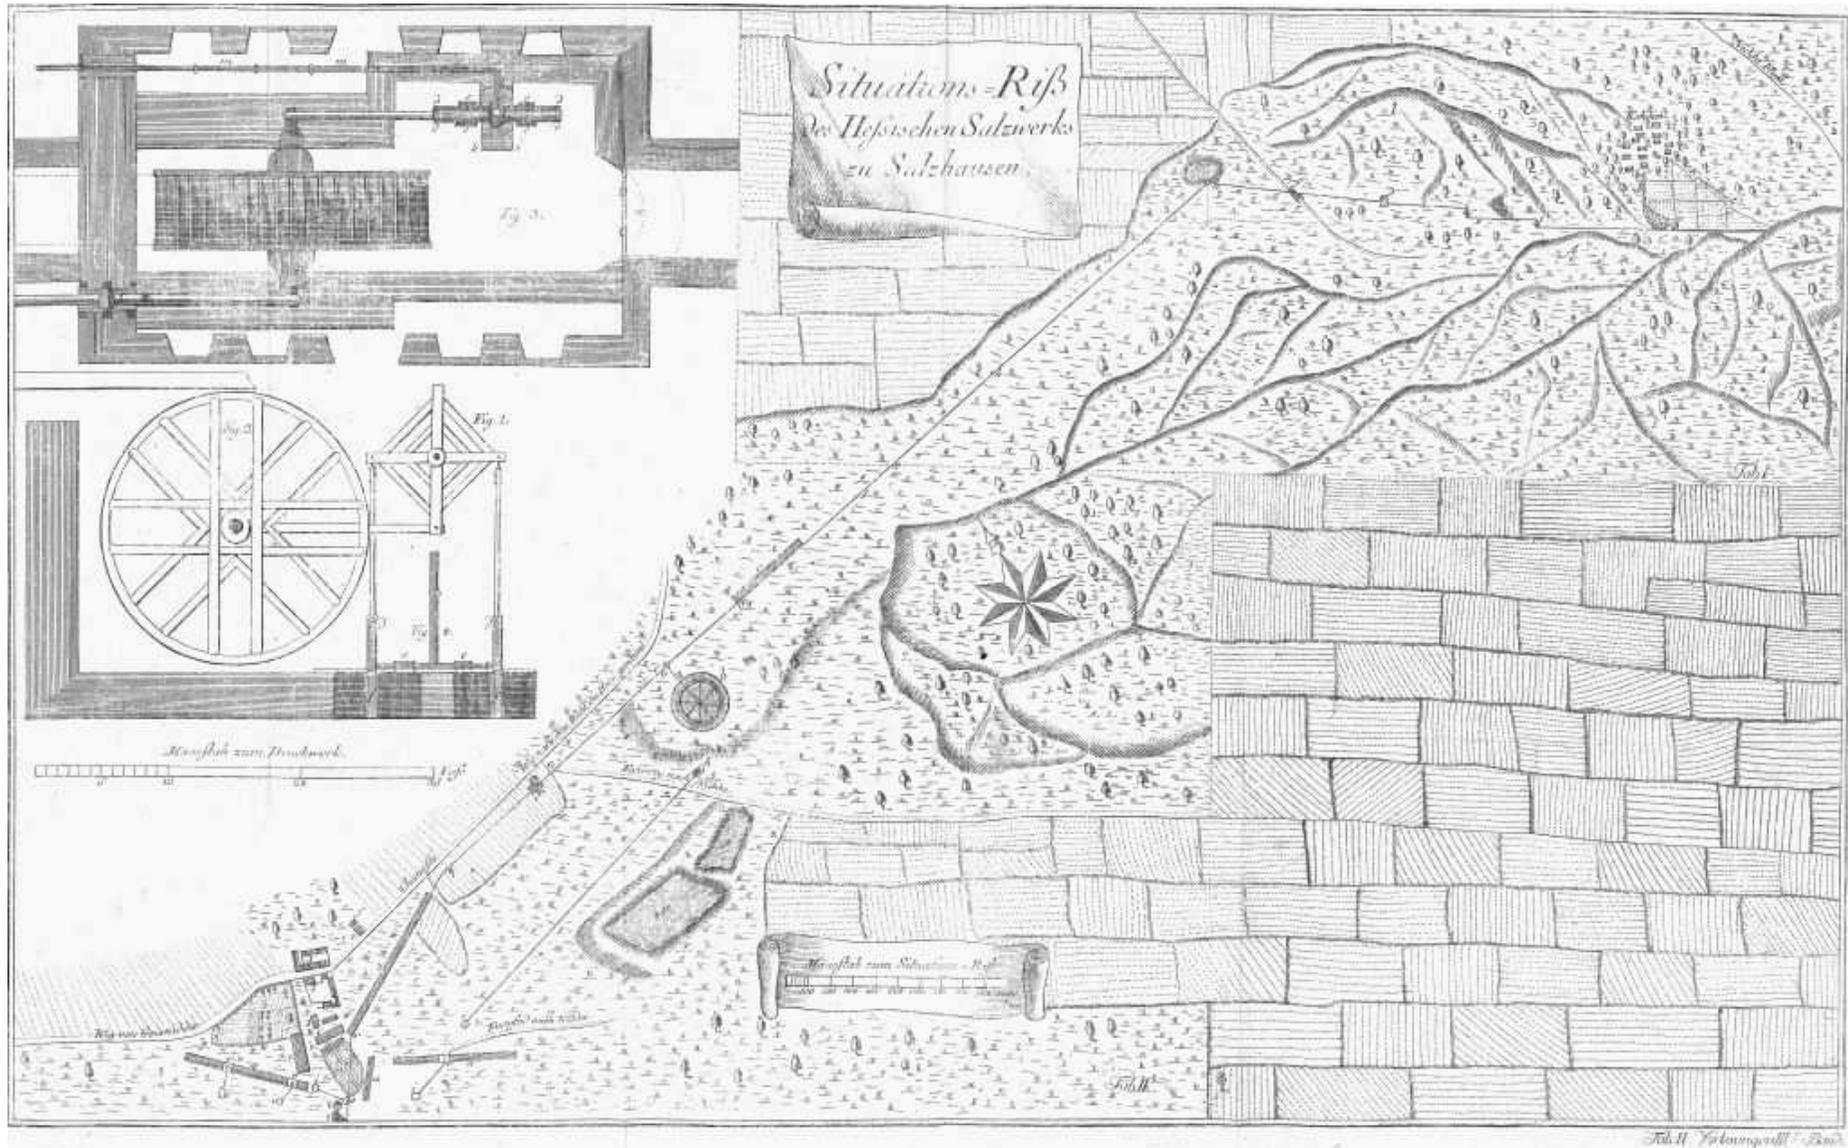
Plan des Salzwerkes mit Stangenkunst bis Kohden aus dem Jahr 1788
